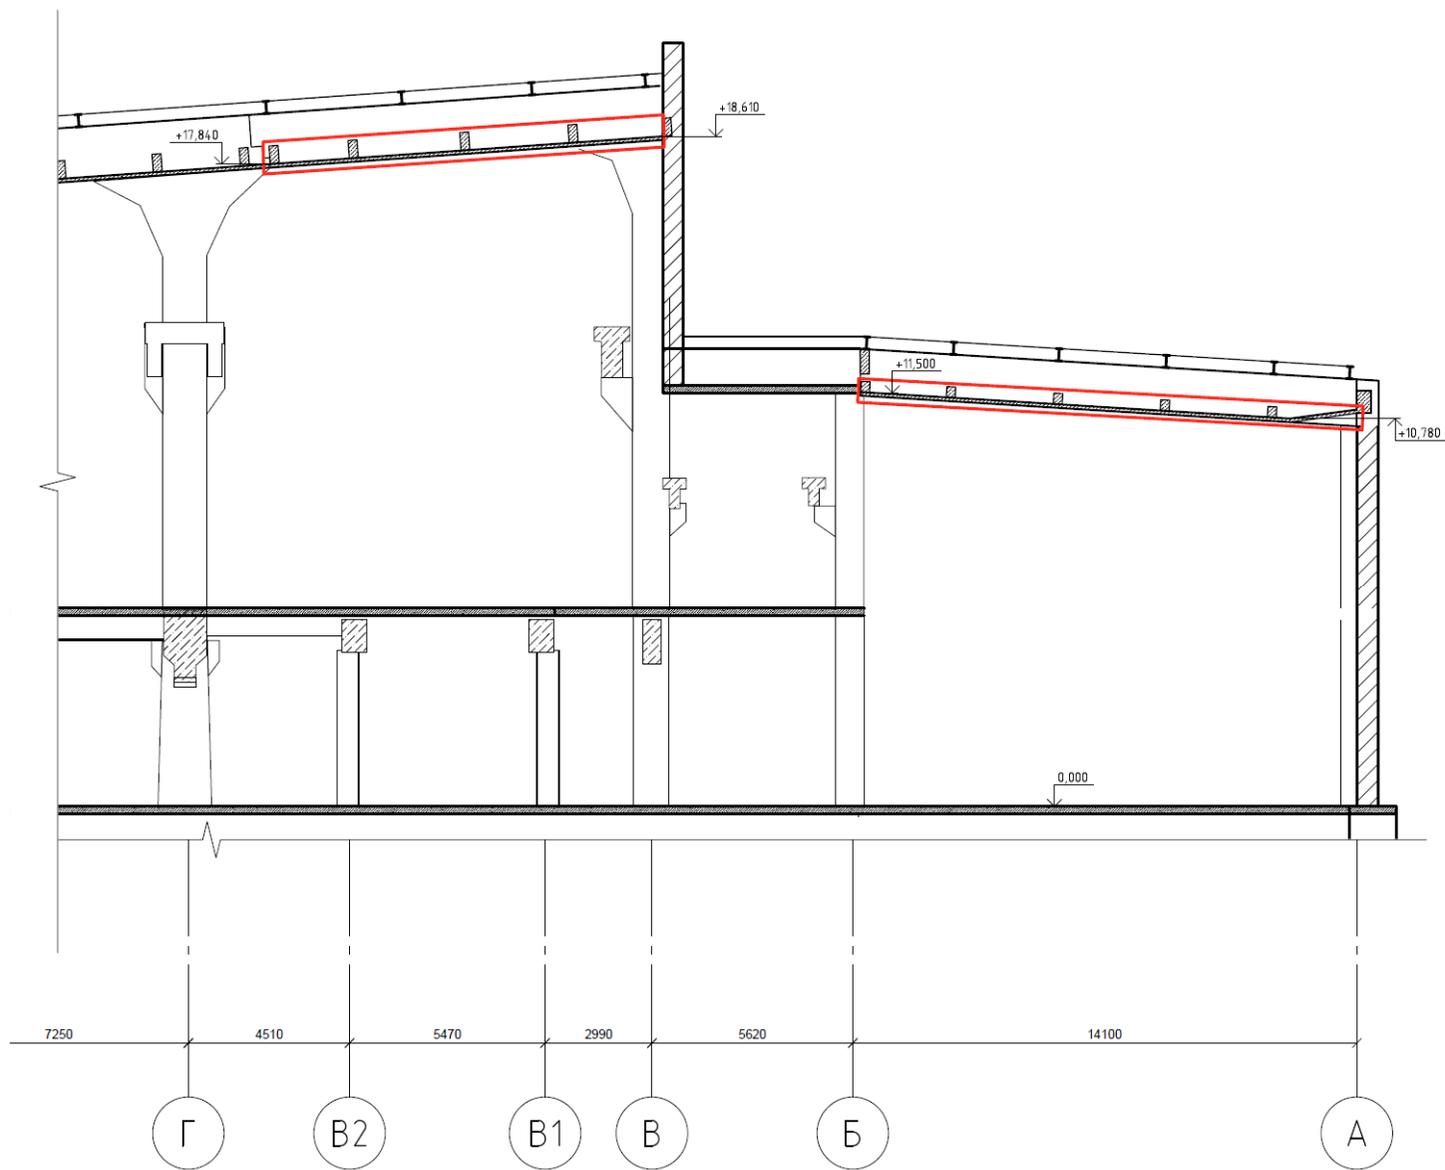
Схематичный разрез по зданию в осях А-Г/16-17 с указанием аварийных участков перекрытия
